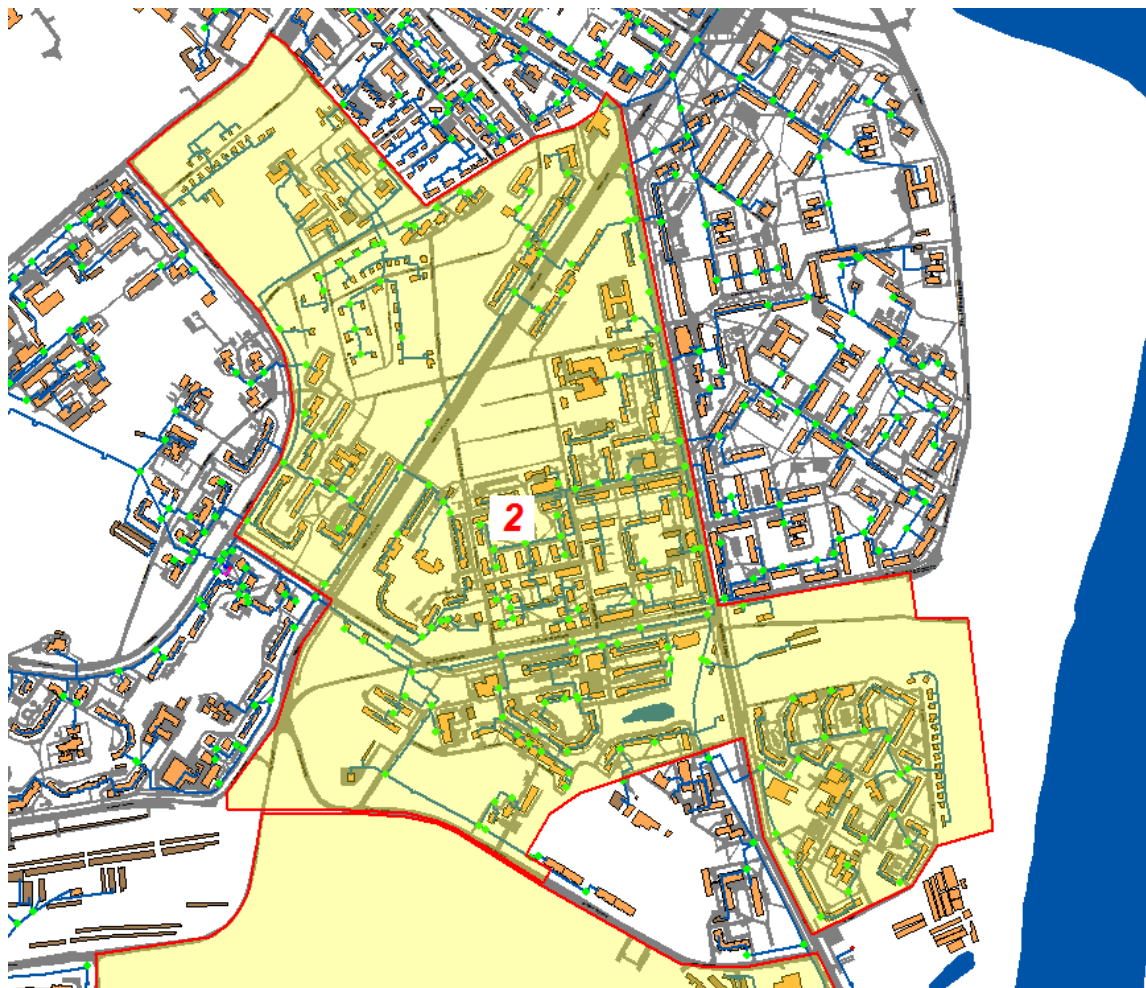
Схема расположения площадки № 2 и тепловых сетей
